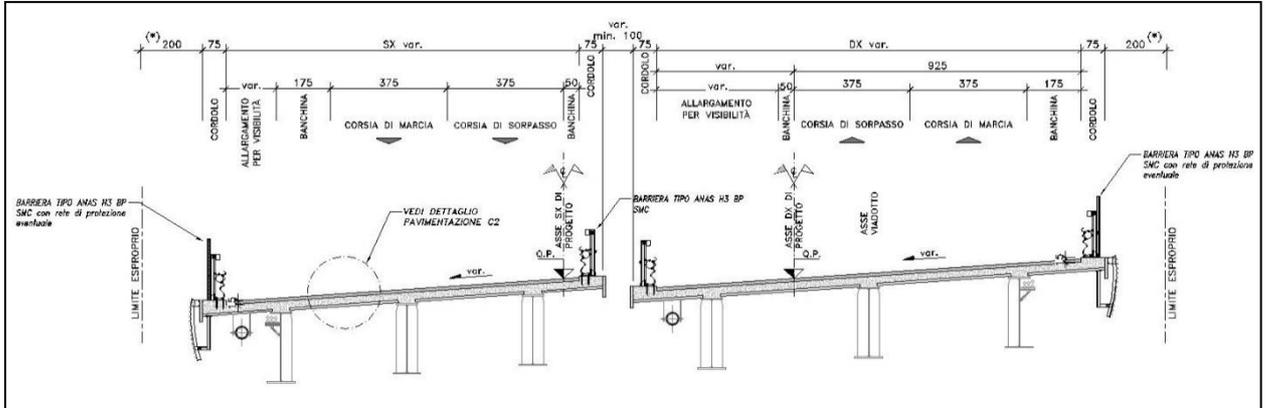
Sezione tipo B con una carreggiata in viadotto.
